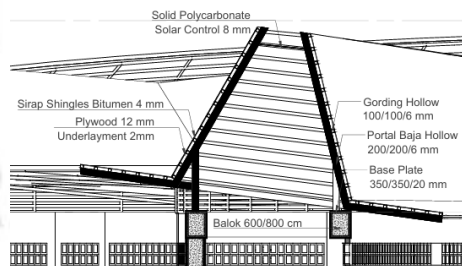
Sistem Struktur Kolom dan Balok Beton Bertulang
